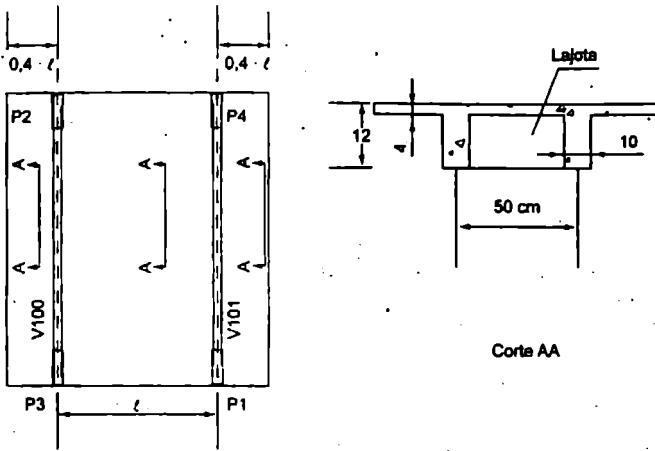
Pavimento composto de duas vigas e laje  $\beta_{12}$ .
